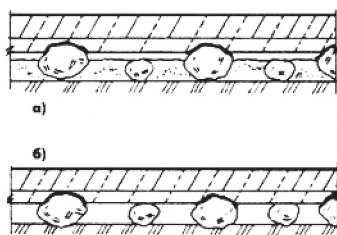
Поперечный разрез фрагмента сейсмостойкого фундамента до осадки здания (а) и после стабилизации осадок (б)
